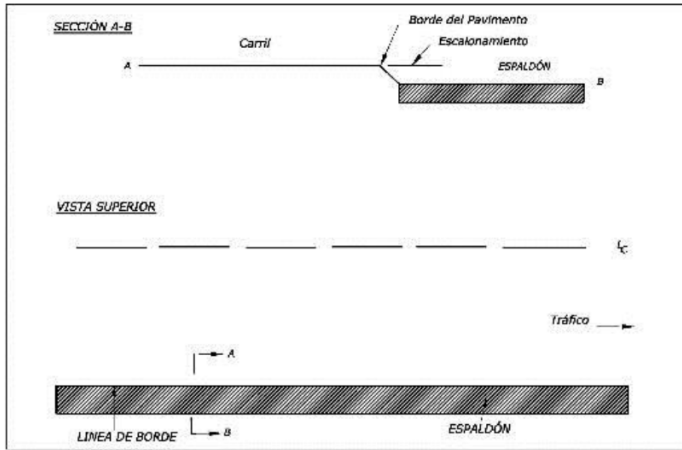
Esquema Escalonamiento entre la Calzada y el Espaldón- Pavimento Flexible
